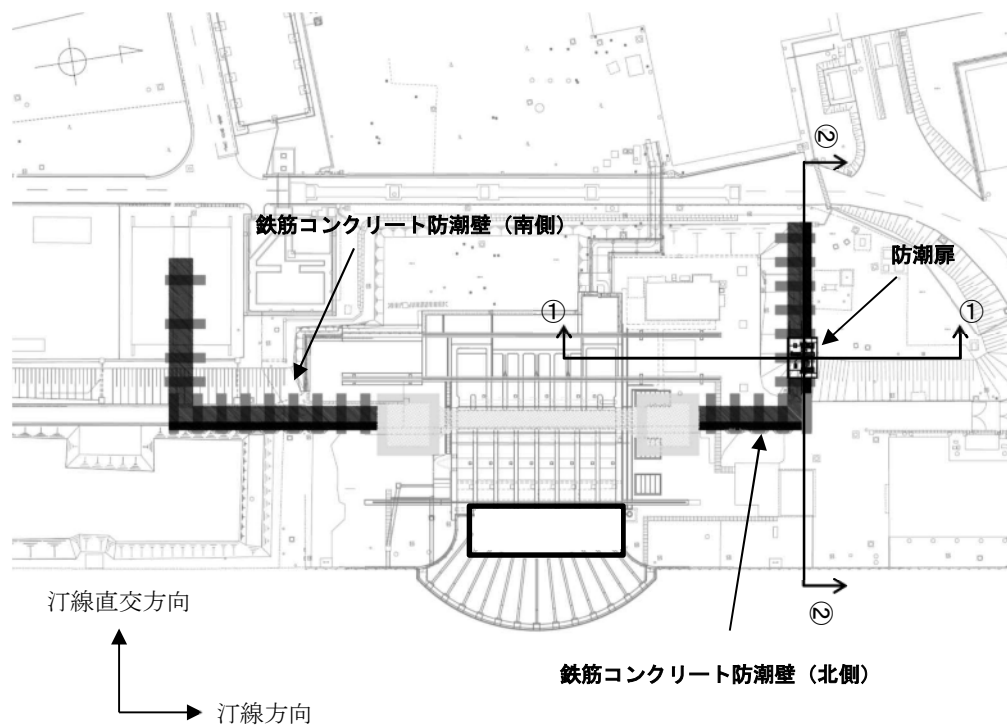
鉄筋コンクリート防潮壁の検討対象断面位置図
